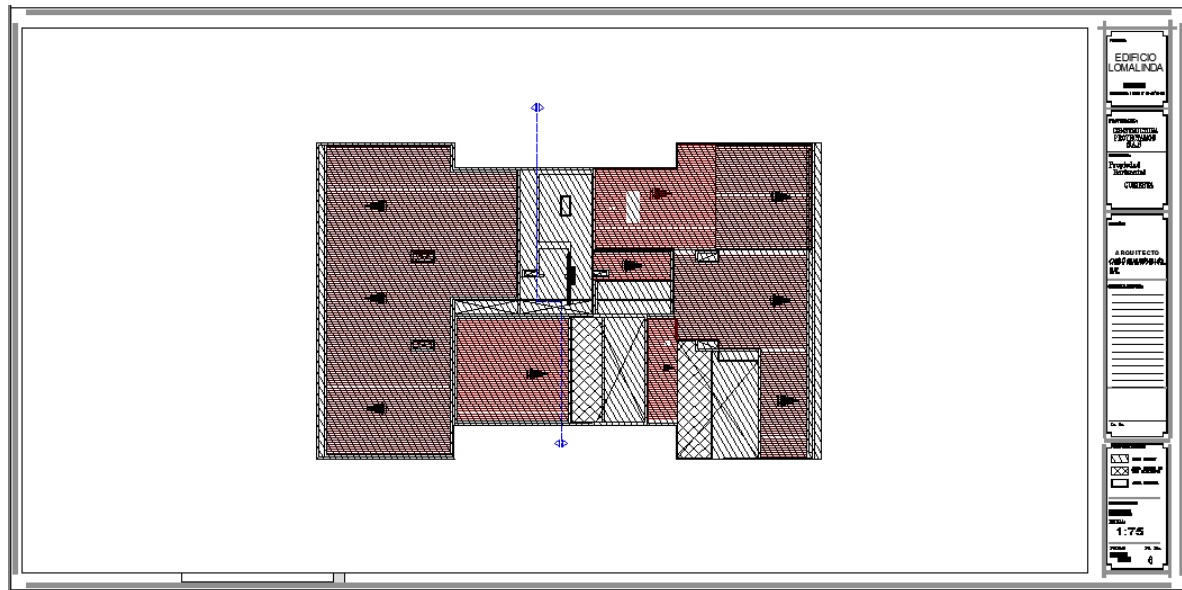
PLANO PROPIEDAD HORIZONTAL – PLANO 5.
